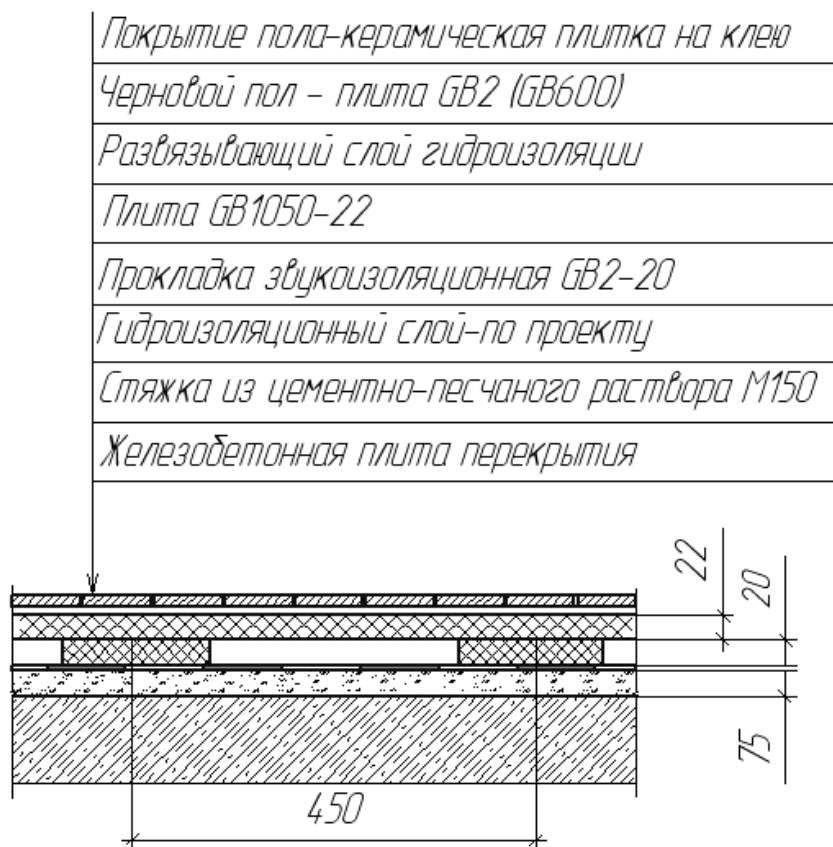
Конструкция «плавающего» пола по плите перекрытия с покрытием керамической плиткой
